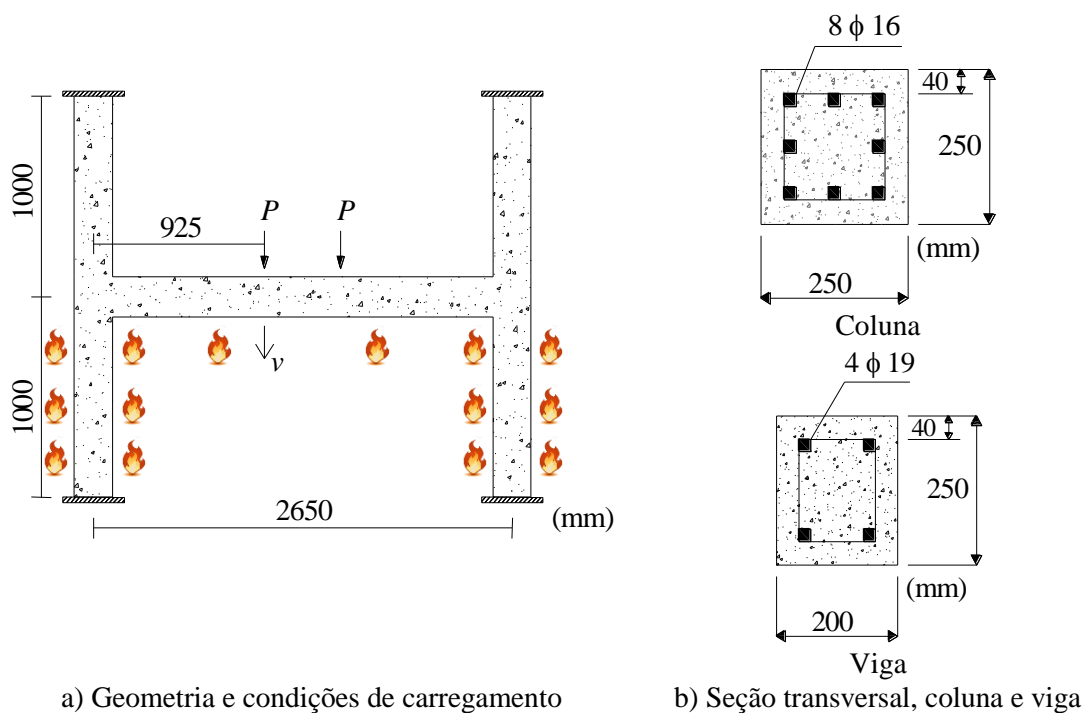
Pórtico plano de Raouffard e Nishiyama (2015): características gerais
